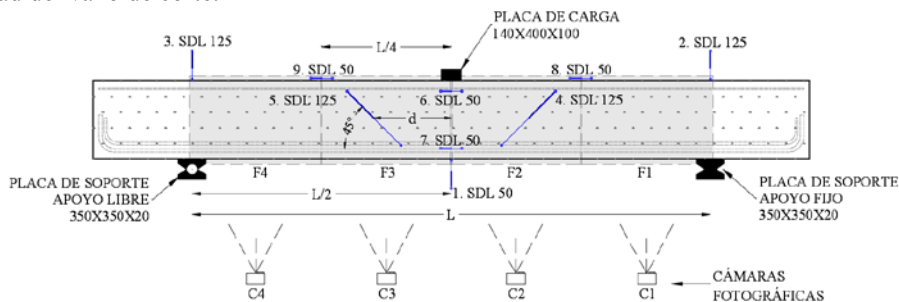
Configuración e instrumentación de ensayo de vigas a tres puntos
